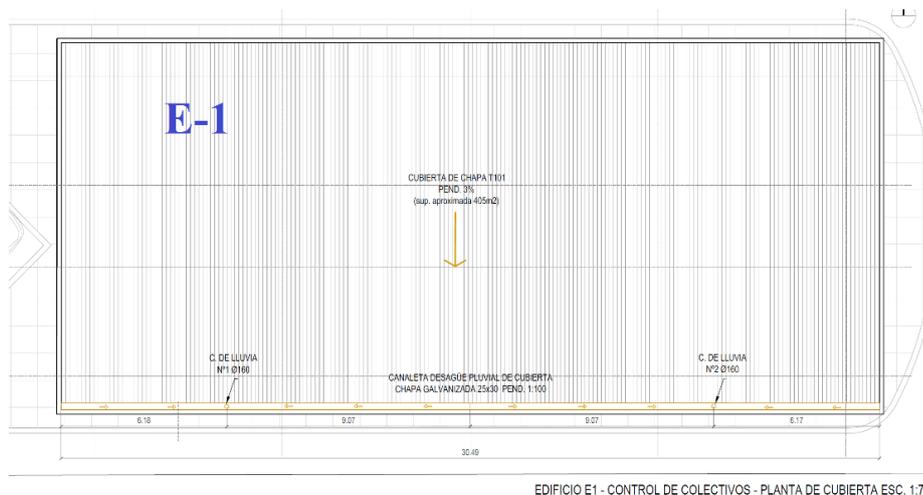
Planta de techos Edificio E1 a desaguar en paso fronterizo La Quiaca - Provincia de Jujuy
